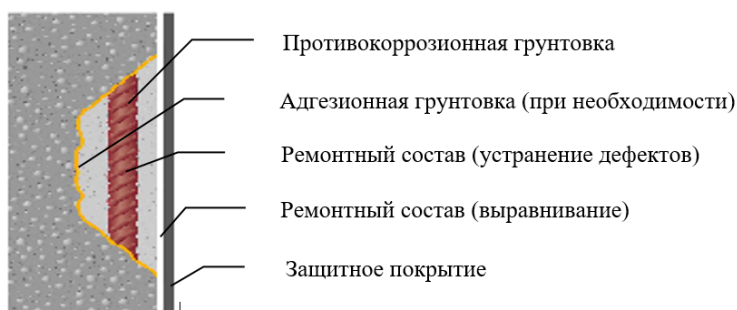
Принципиальная схема ремонта и защиты бетонных и железобетонных конструкций
